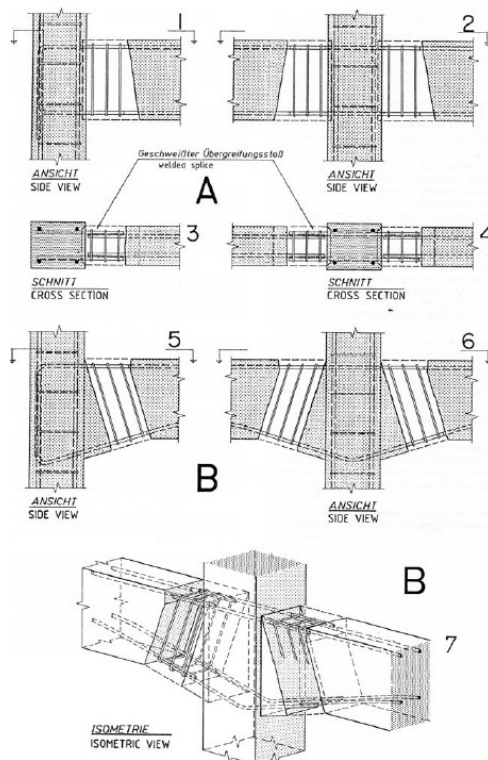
Ligação por betonagem *in situ* (Stupré, 1981)
